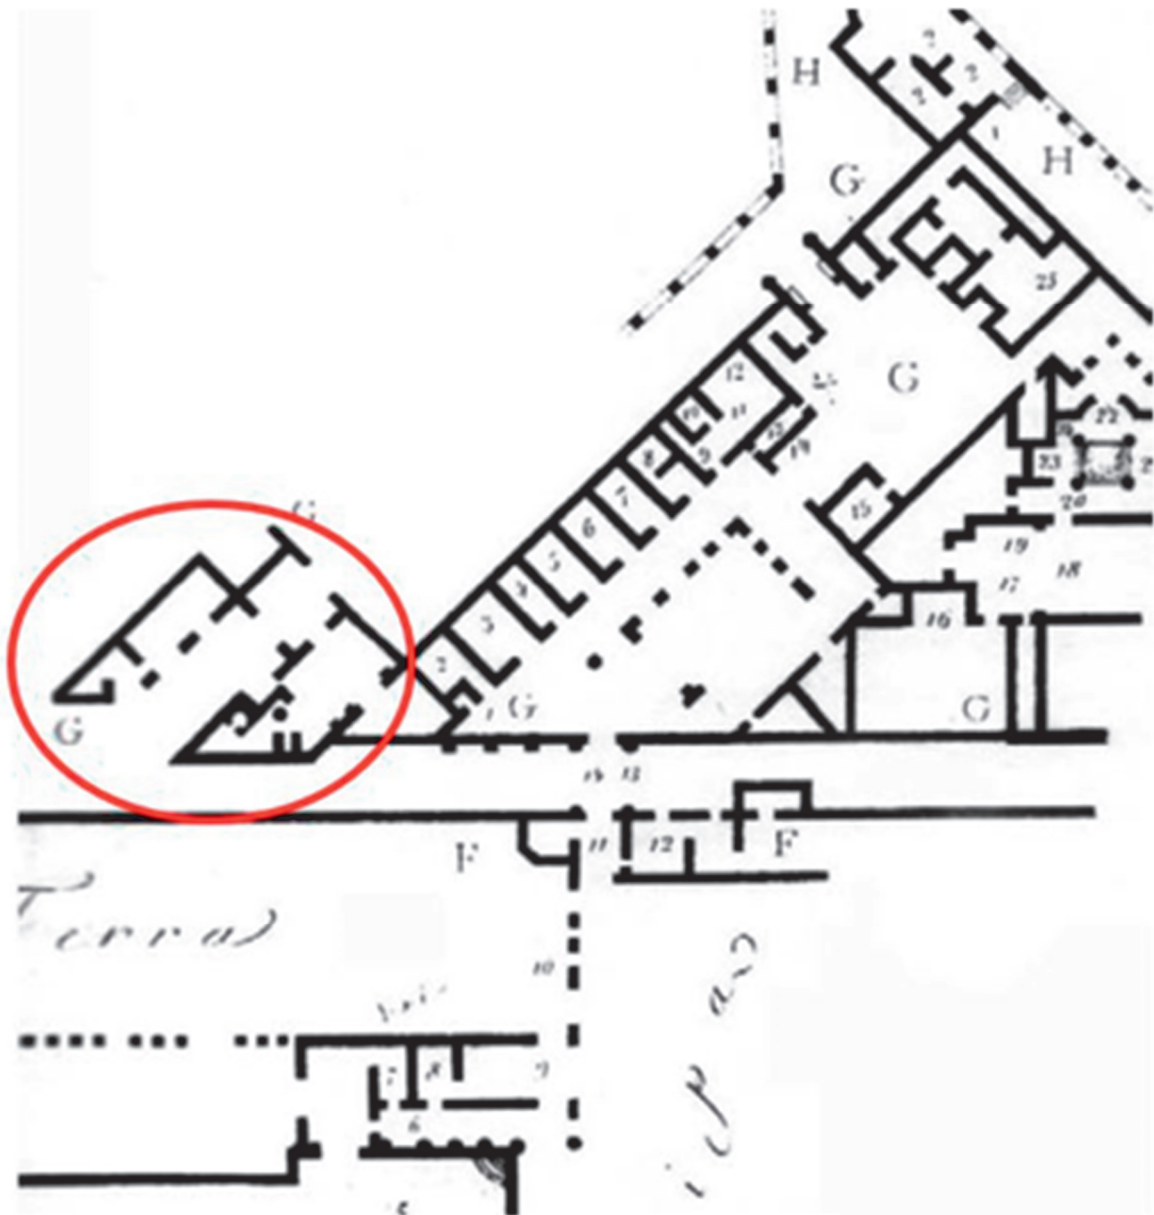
Villa San Marco, stralcio della planimetria del Weber. In rosso le possibili strutture individuate grazie all'ausilio della strumentazione geofisica.
